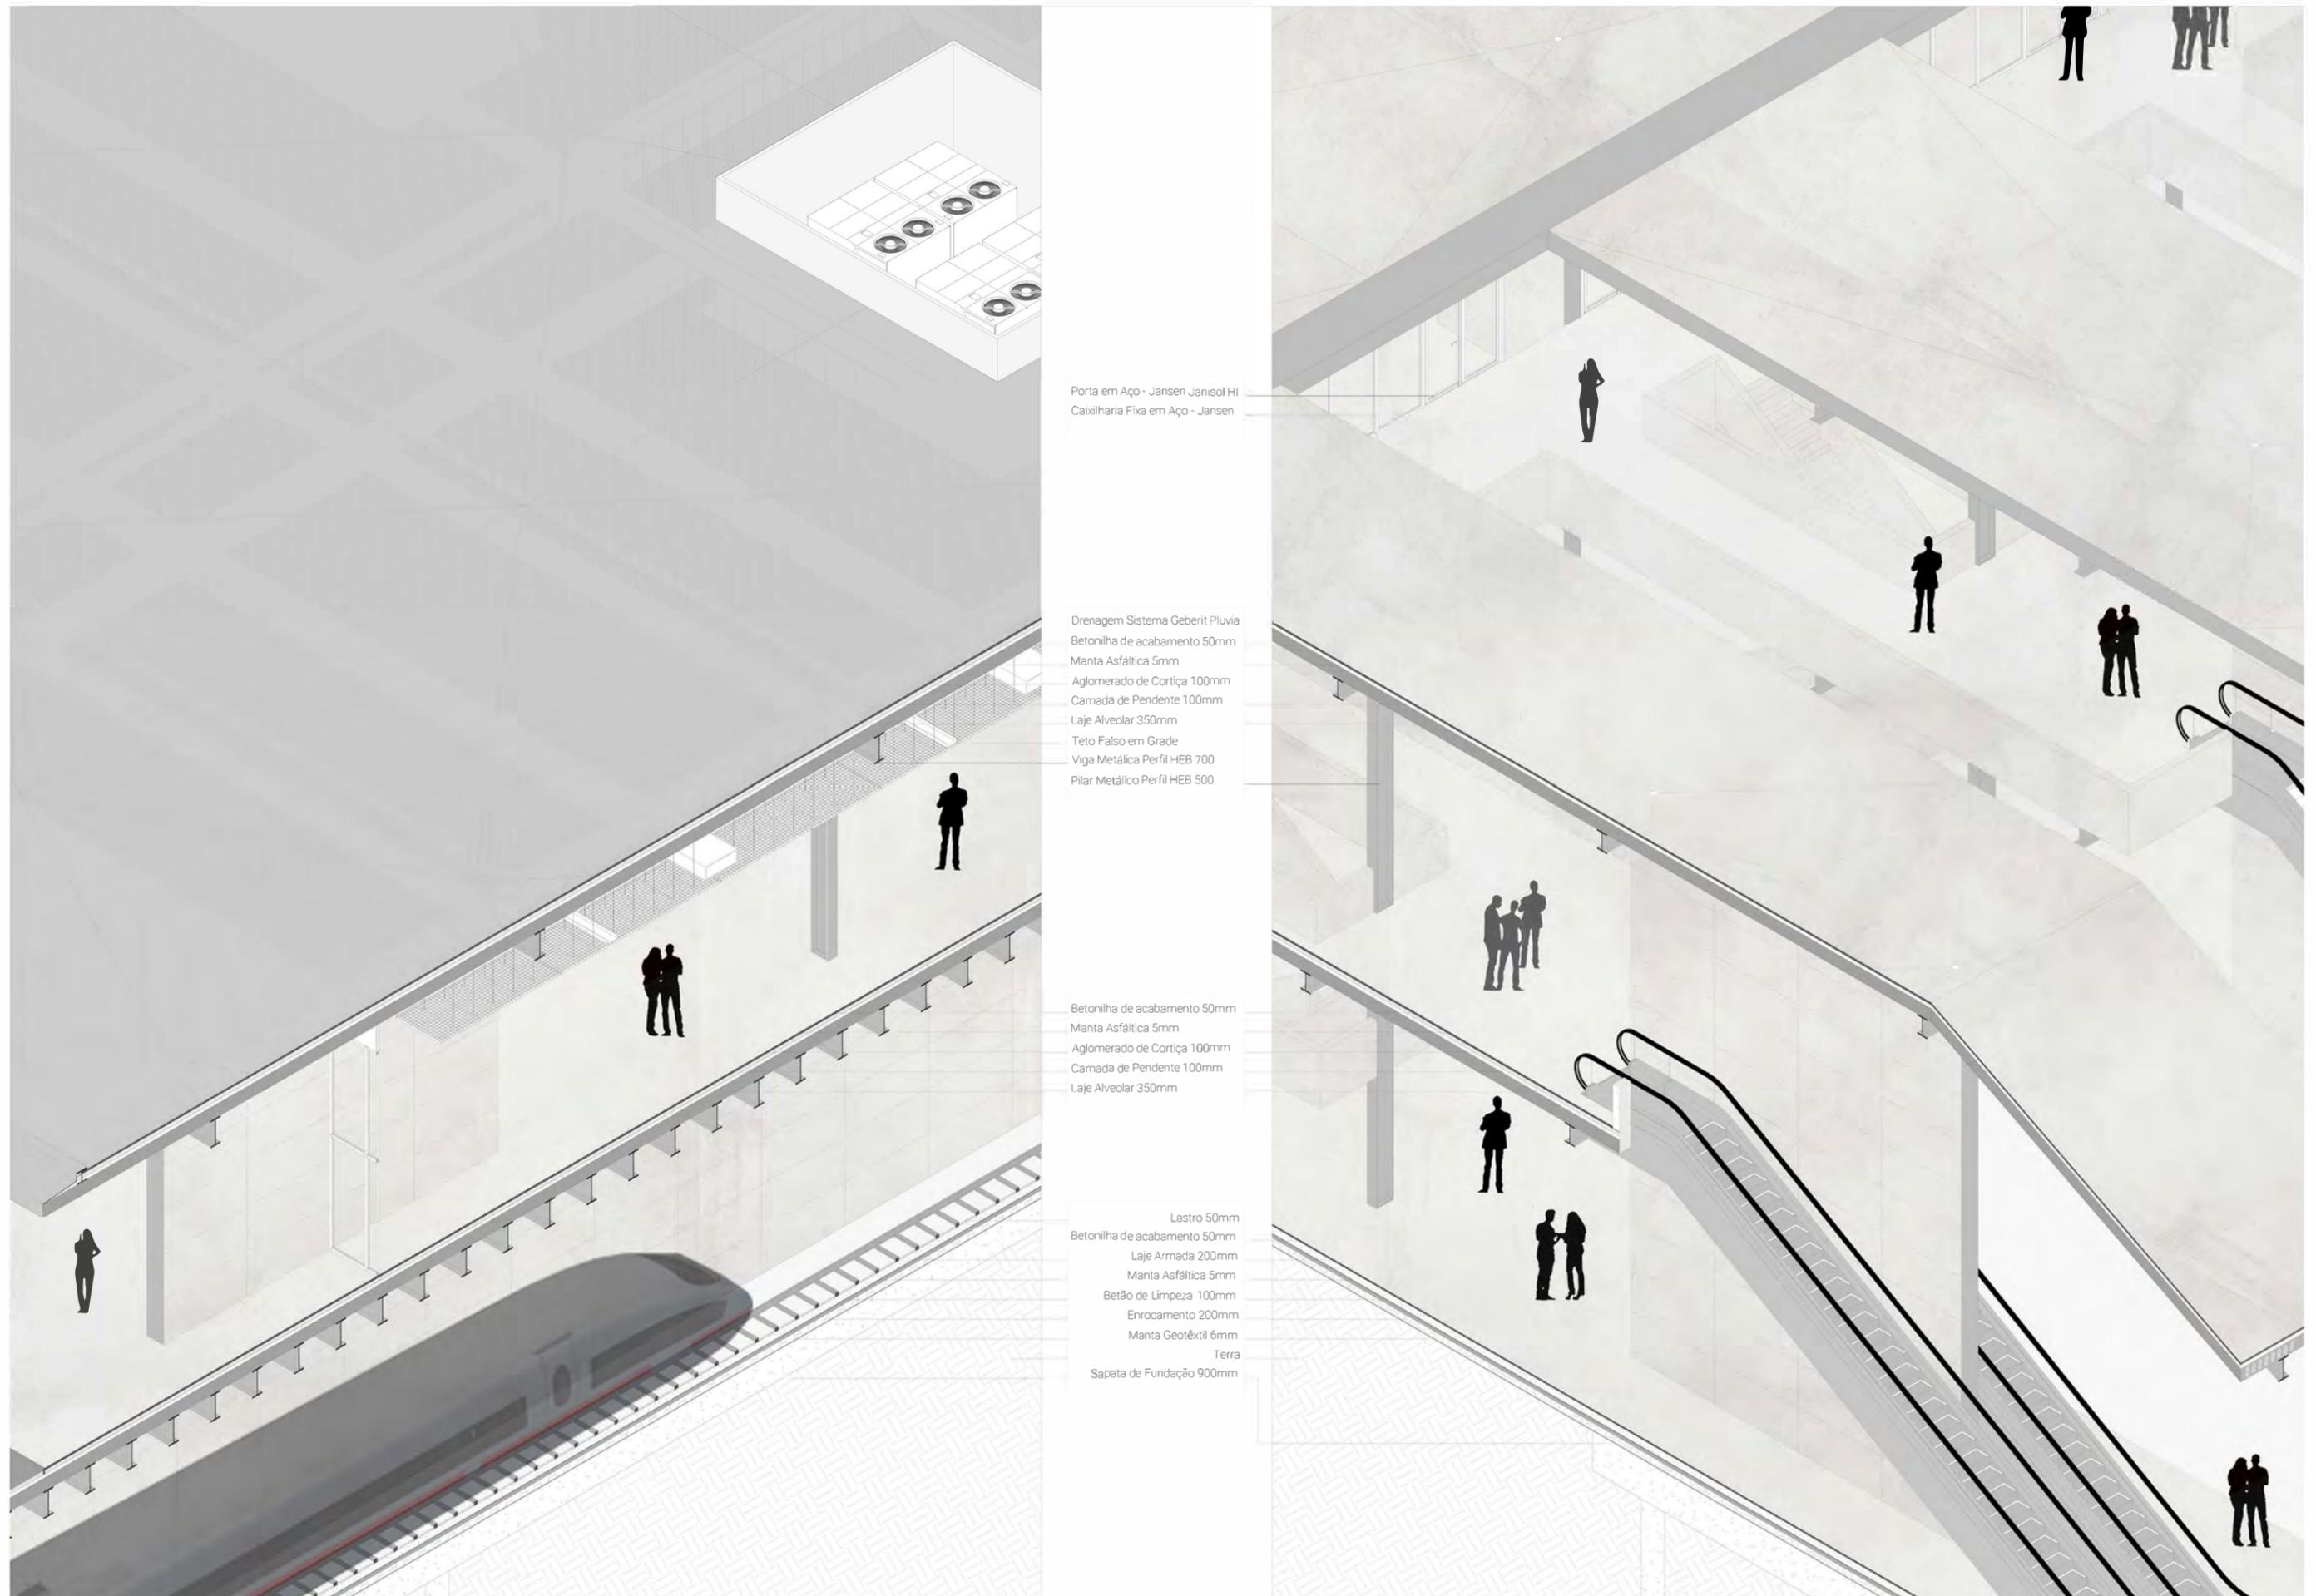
Axonometria seccionada da Estação Ferroviária com detalhe construtivo.
